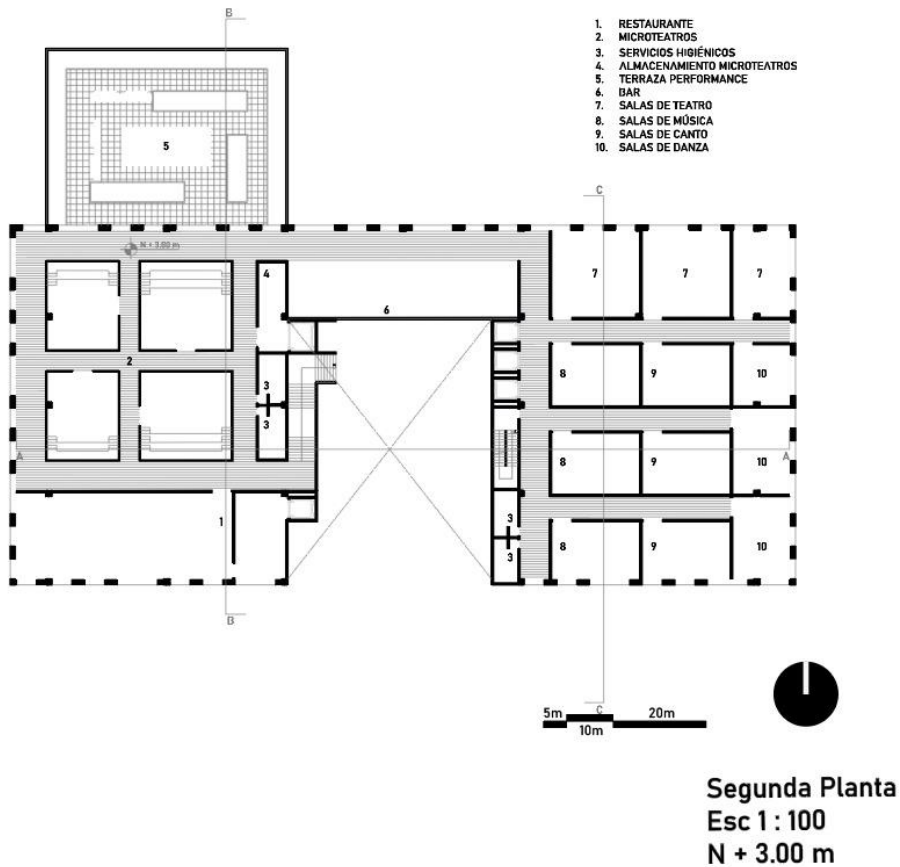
"Segunda Planta Entrega Final" elaboración propia
